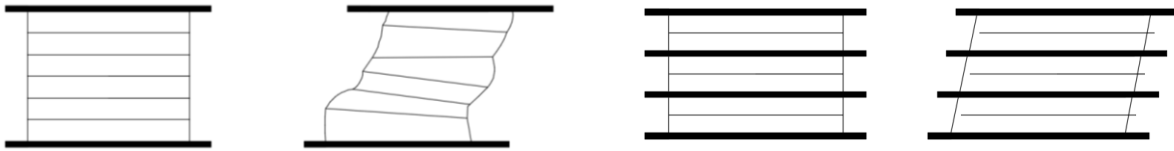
Deformación lateral de un apoyo laminado estándar y un apoyo segmentado (Priestley, et al, 1996)
